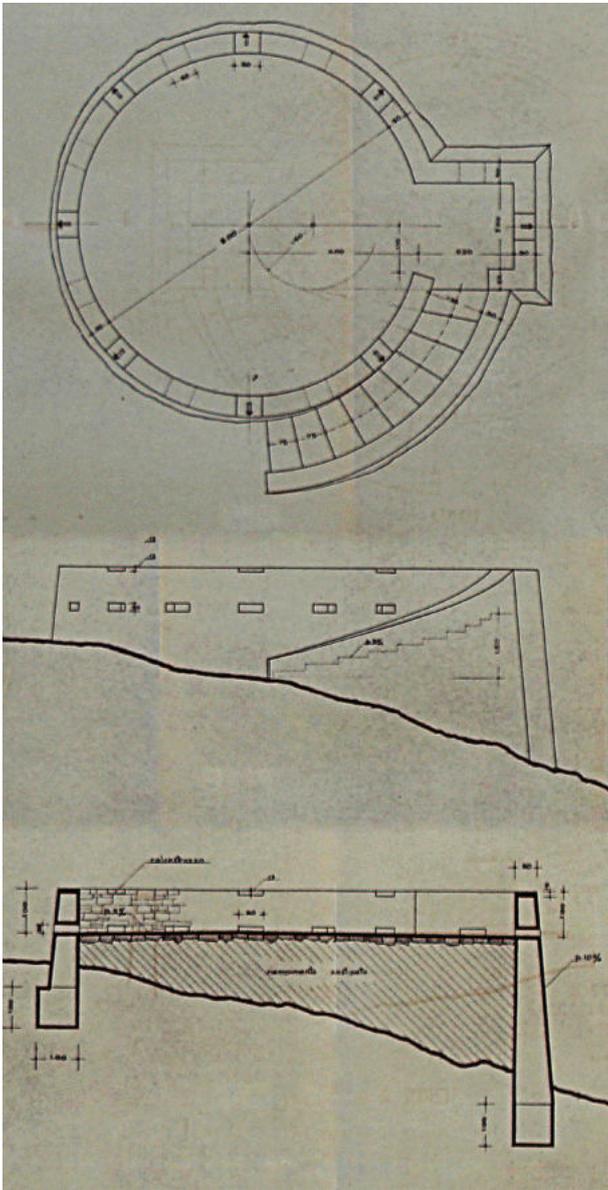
Pianta, prospetto e sezione della rotonda panoramica (Archivio Gurekian).
